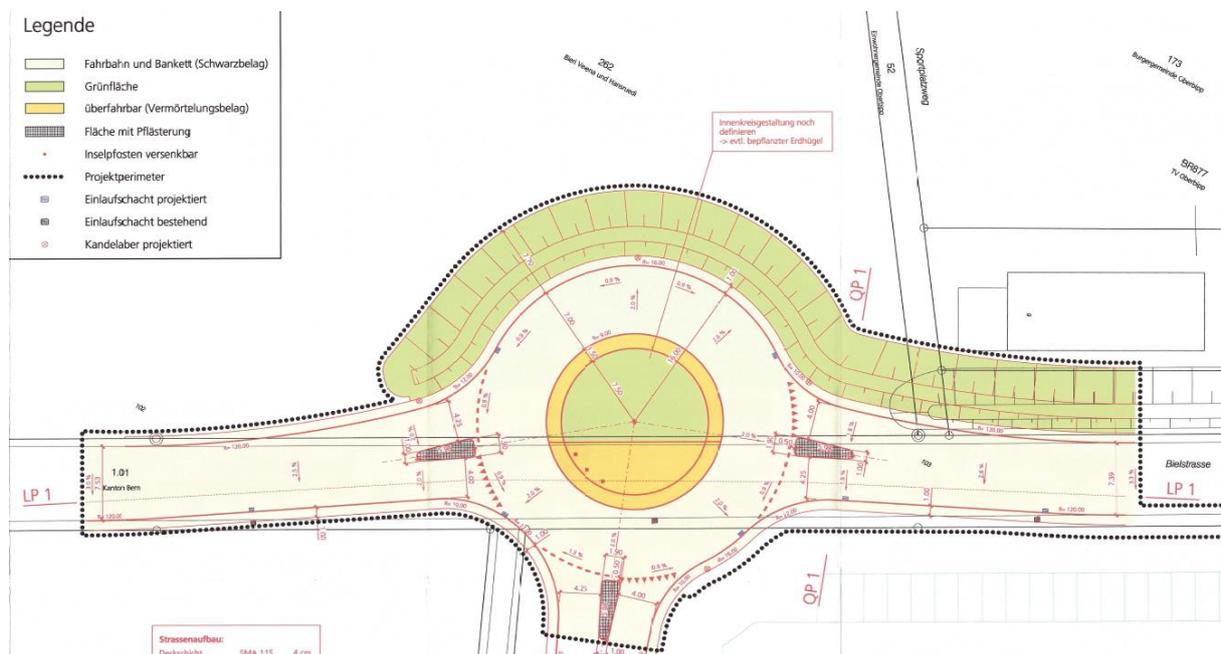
Situation End-Zustandplan Umgestaltung Kantonsstrasse inkl. Anschluss (2009)
